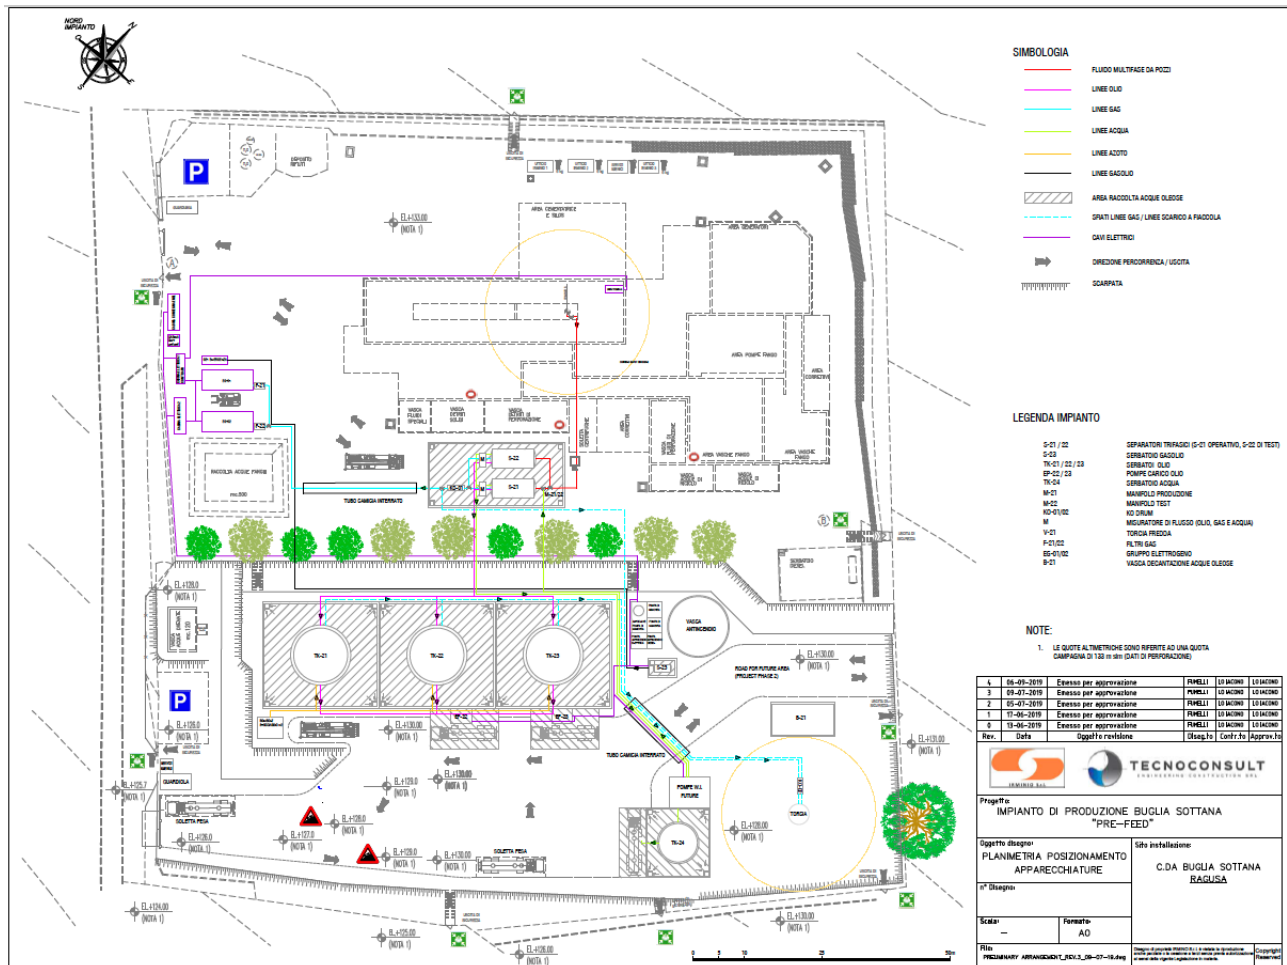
Disposizione planimetrica per la messa in produzione del pozzo Irminio 6 (procedura di assoggettabilità a VIA)
